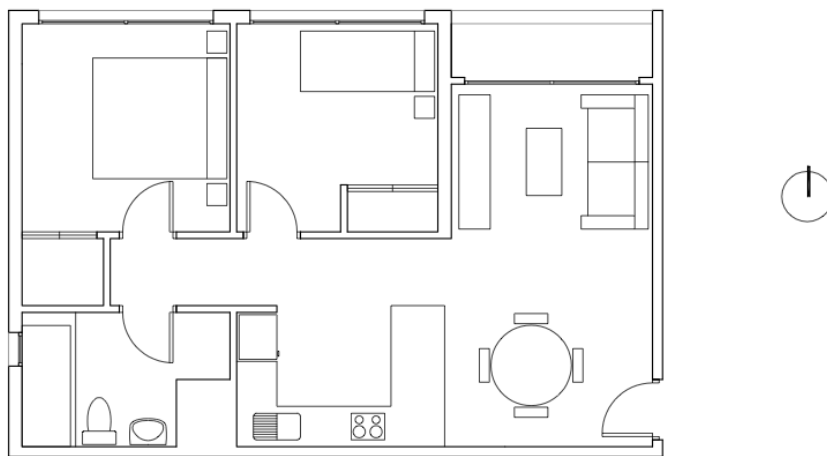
Plano vivienda, Fuente: Elaboración propia
